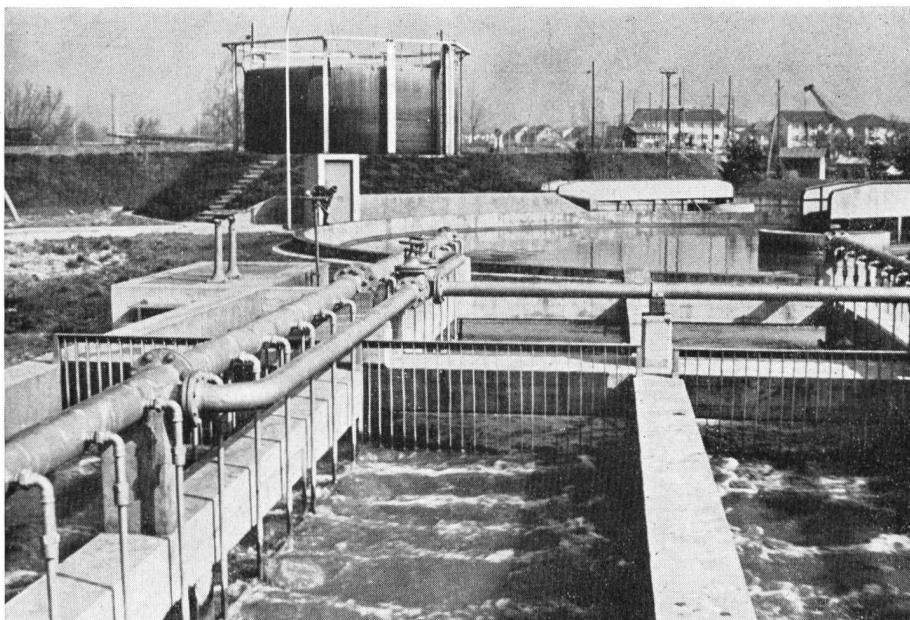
Abwasserreinigungsanlage der Stadt Zug; Tropfkörper und Nachklärbecken.
